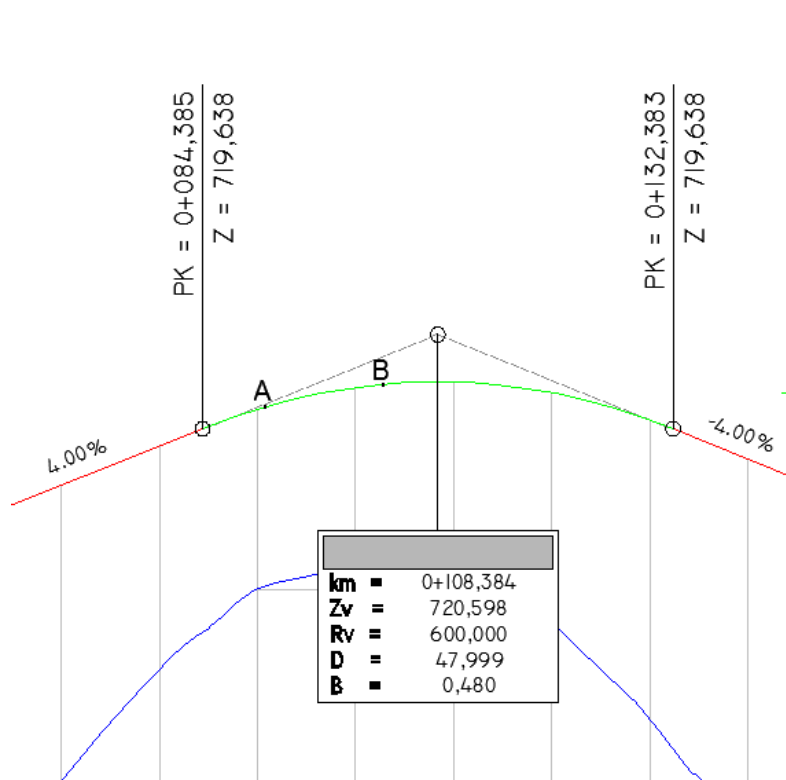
Perfil Longitudinal da Rotunda A – Intersecção com o Ramo C
